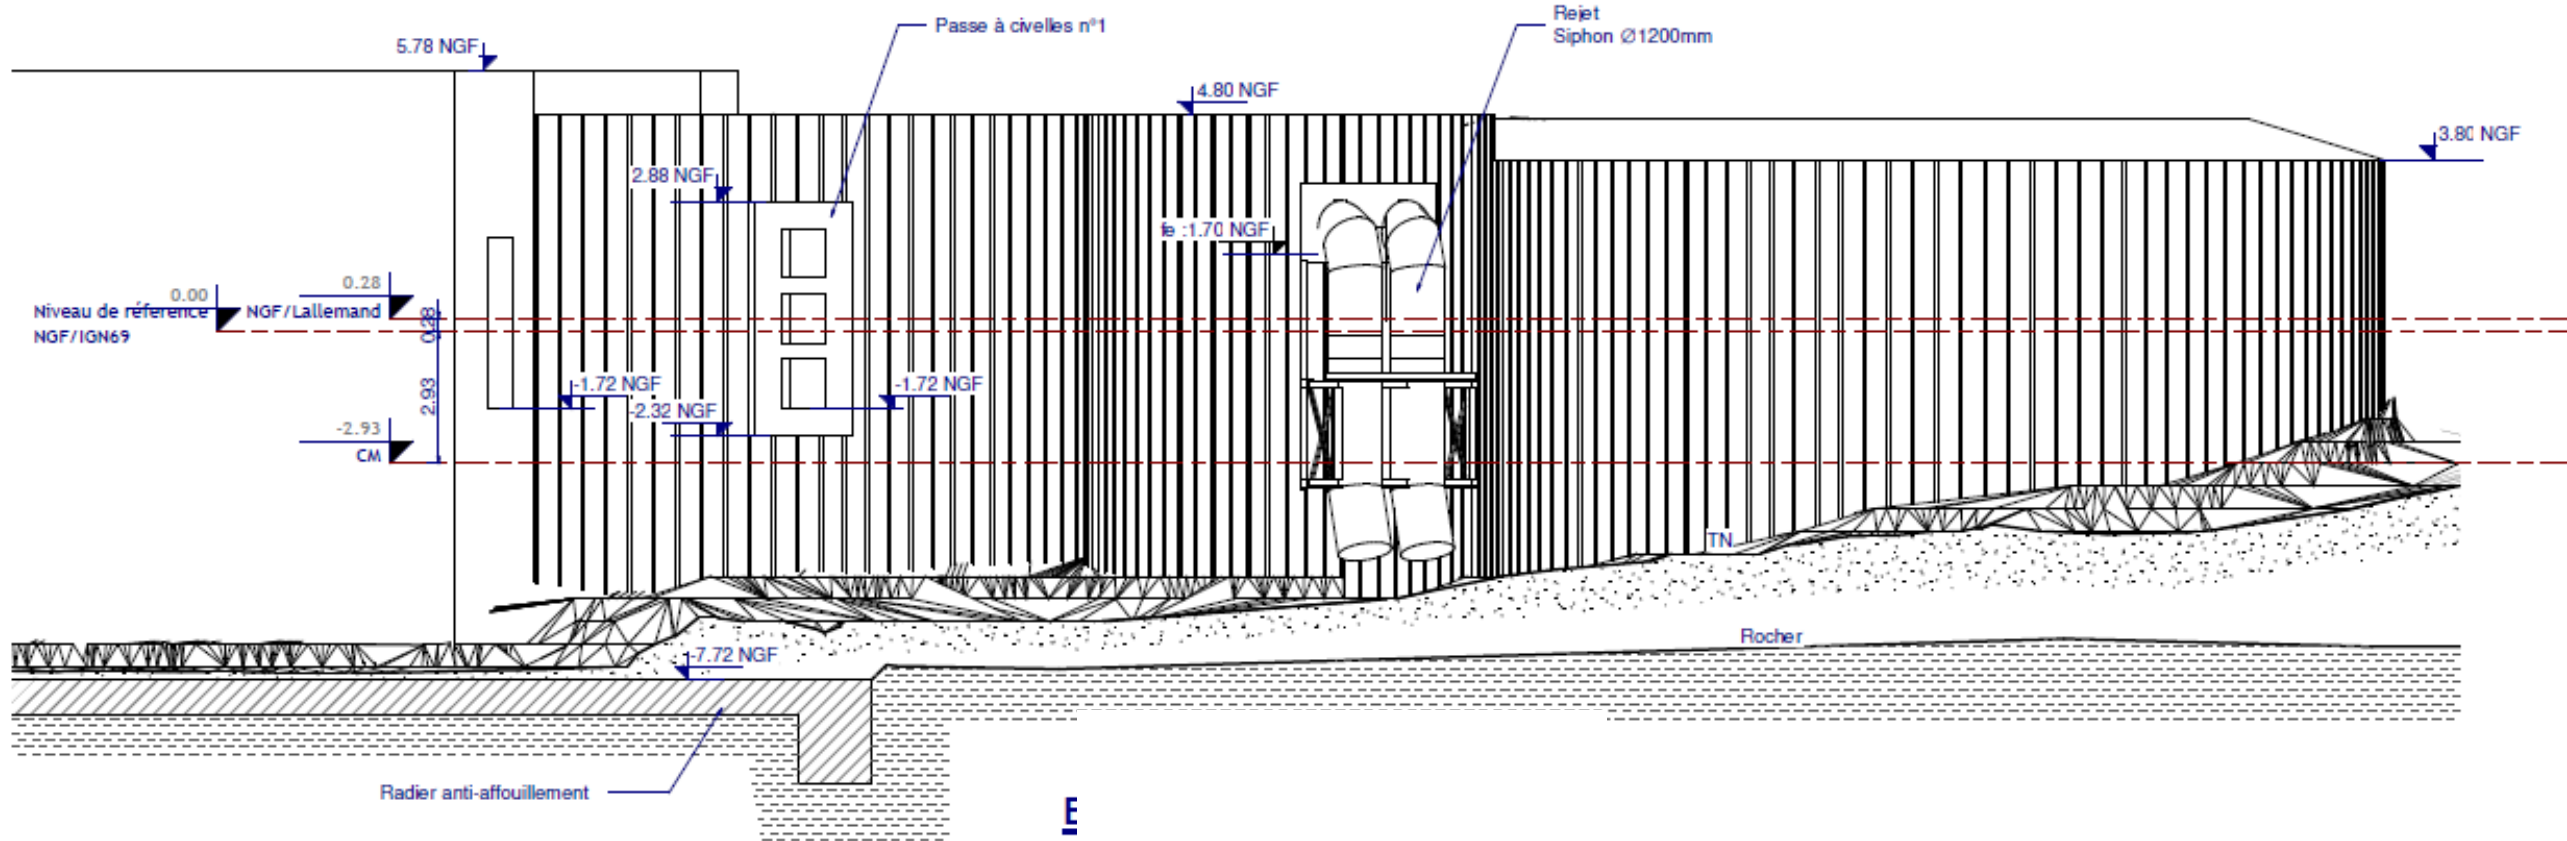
Plan des gabions du barrage d'Arzal – Source : ARTELIA
